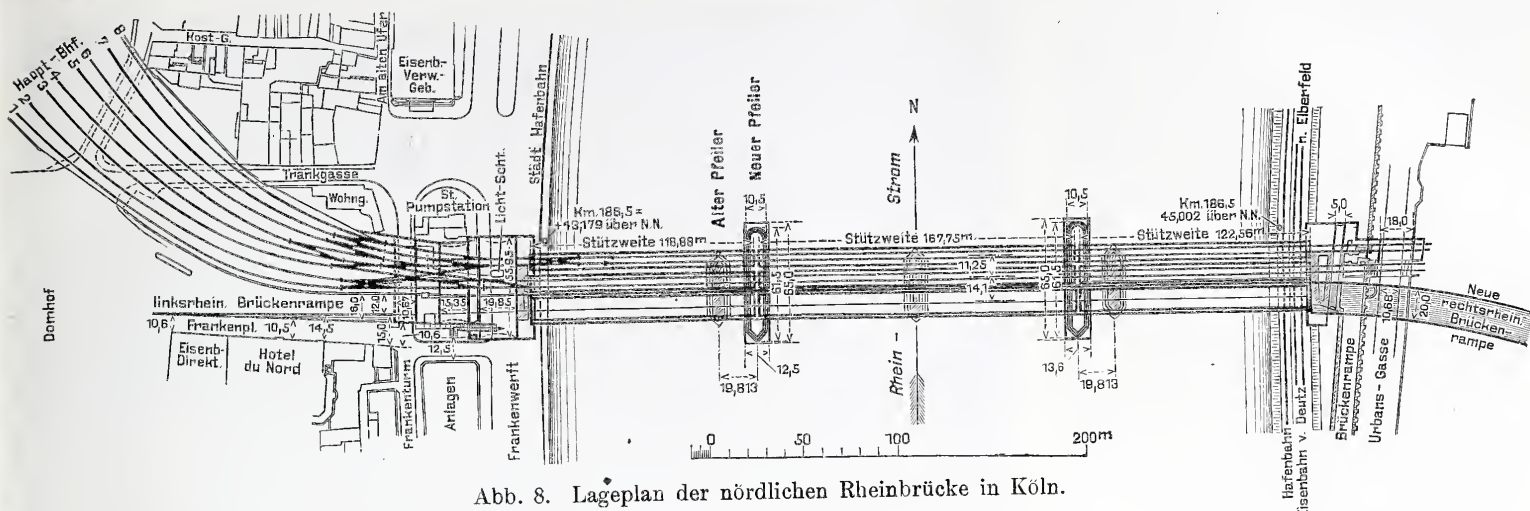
Lageplan der nördlichen Rheinbrücke in Köln.
